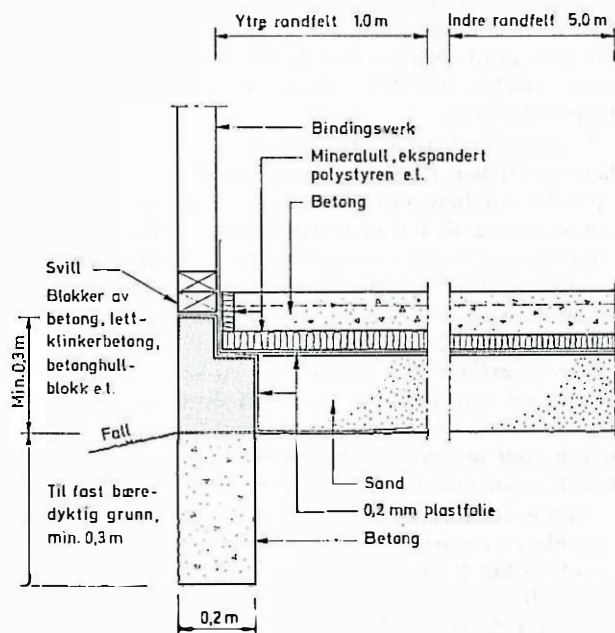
Fundamentering på ringmur, første etasjes gulv liggende på grunnen.
